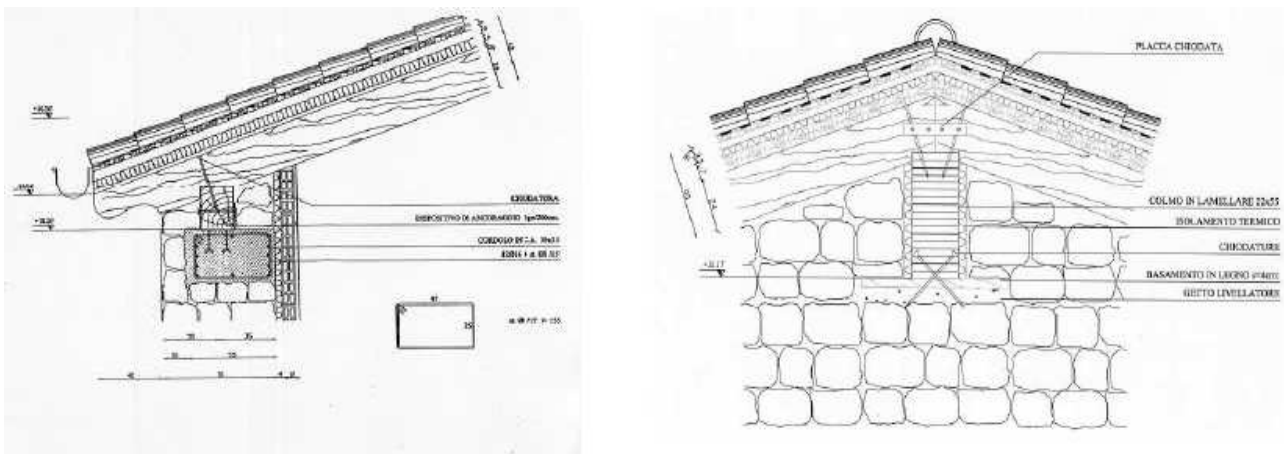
Particolare di cordolo di sottotetto in c.a. e dell'appoggio del colmo sul muro in pietra
